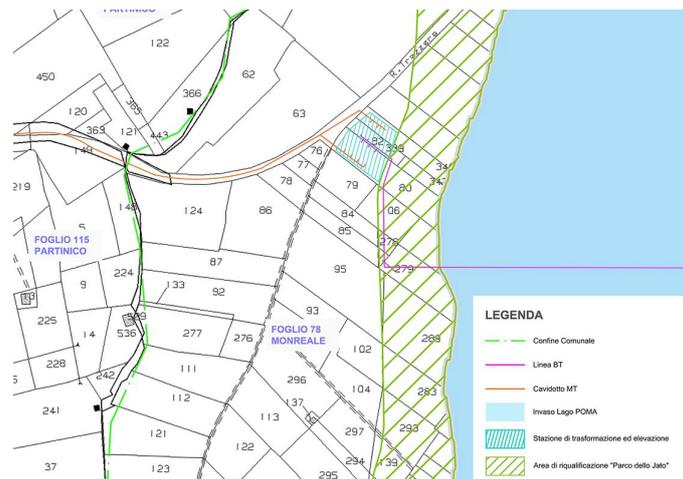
B – Layout della stazione di trasformazione ed elevazione con cavidotto
